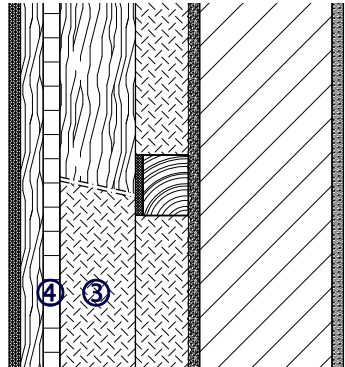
Erläuterungen zum Konstruktionsaufbau (Horizontalschnitte)
